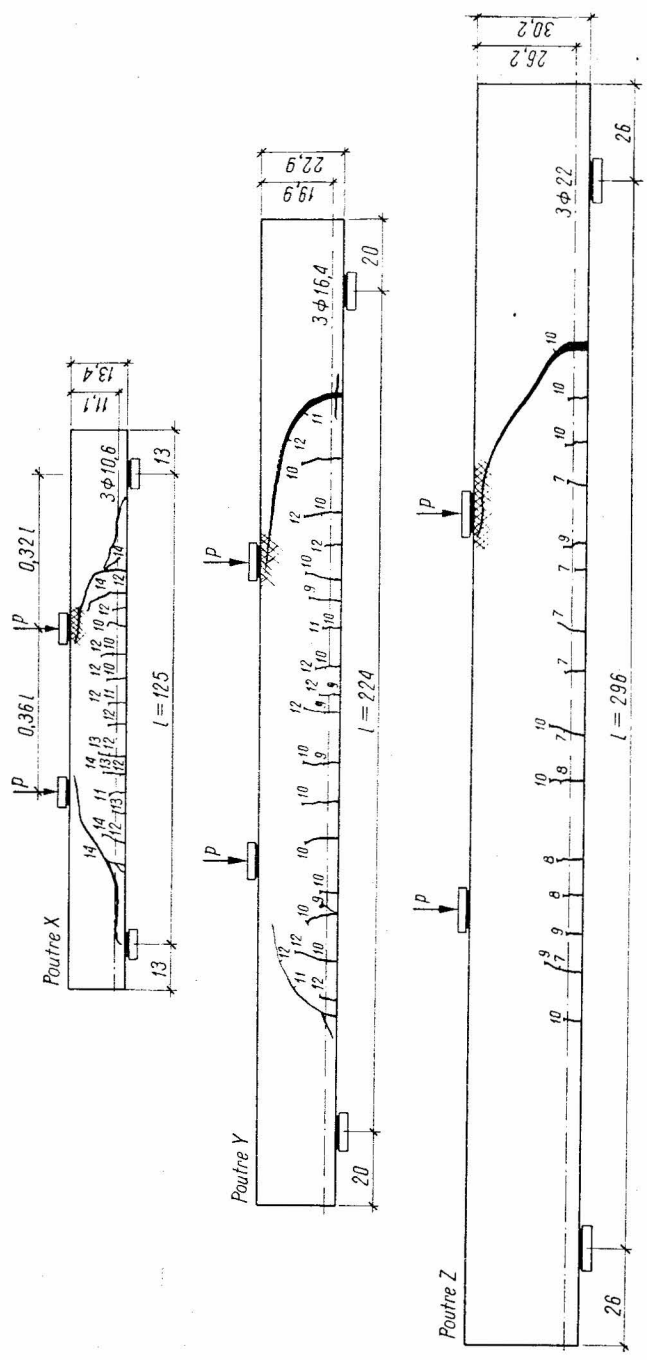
Influence des dimensions absolues d'une poutre sur la morphologie des fissures, d'après les essais de RÜSCH, HAUGLI, MAYER [72]
